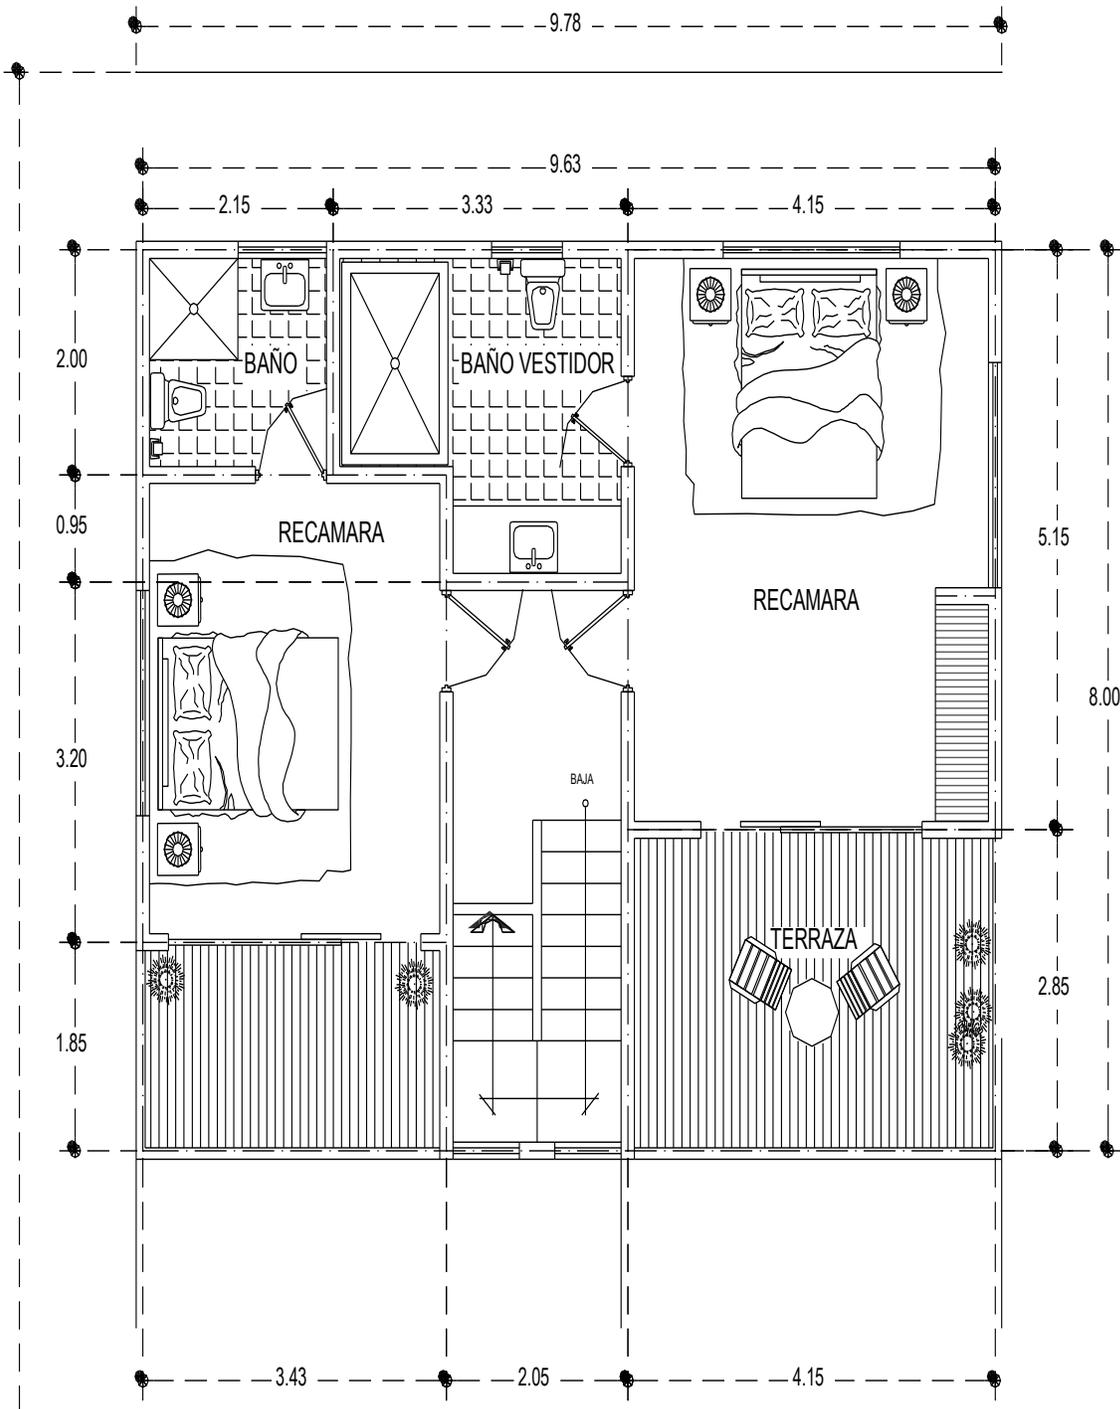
Planta arquitectónica alta de la casa habitación.
